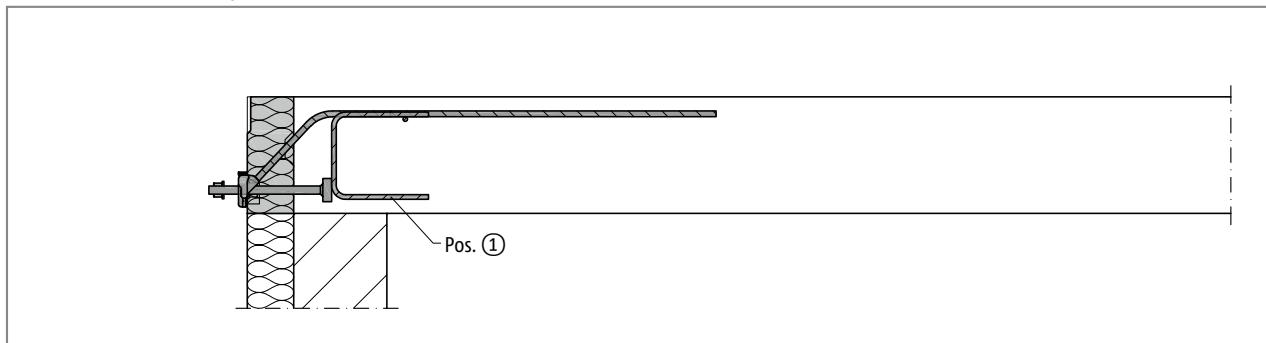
Schöck Isokorb® T type SQ: Op de werf aangebrachte brandwerende bekleding, T type SQ, staalconstructie met brandwerende coating; doorsnede
